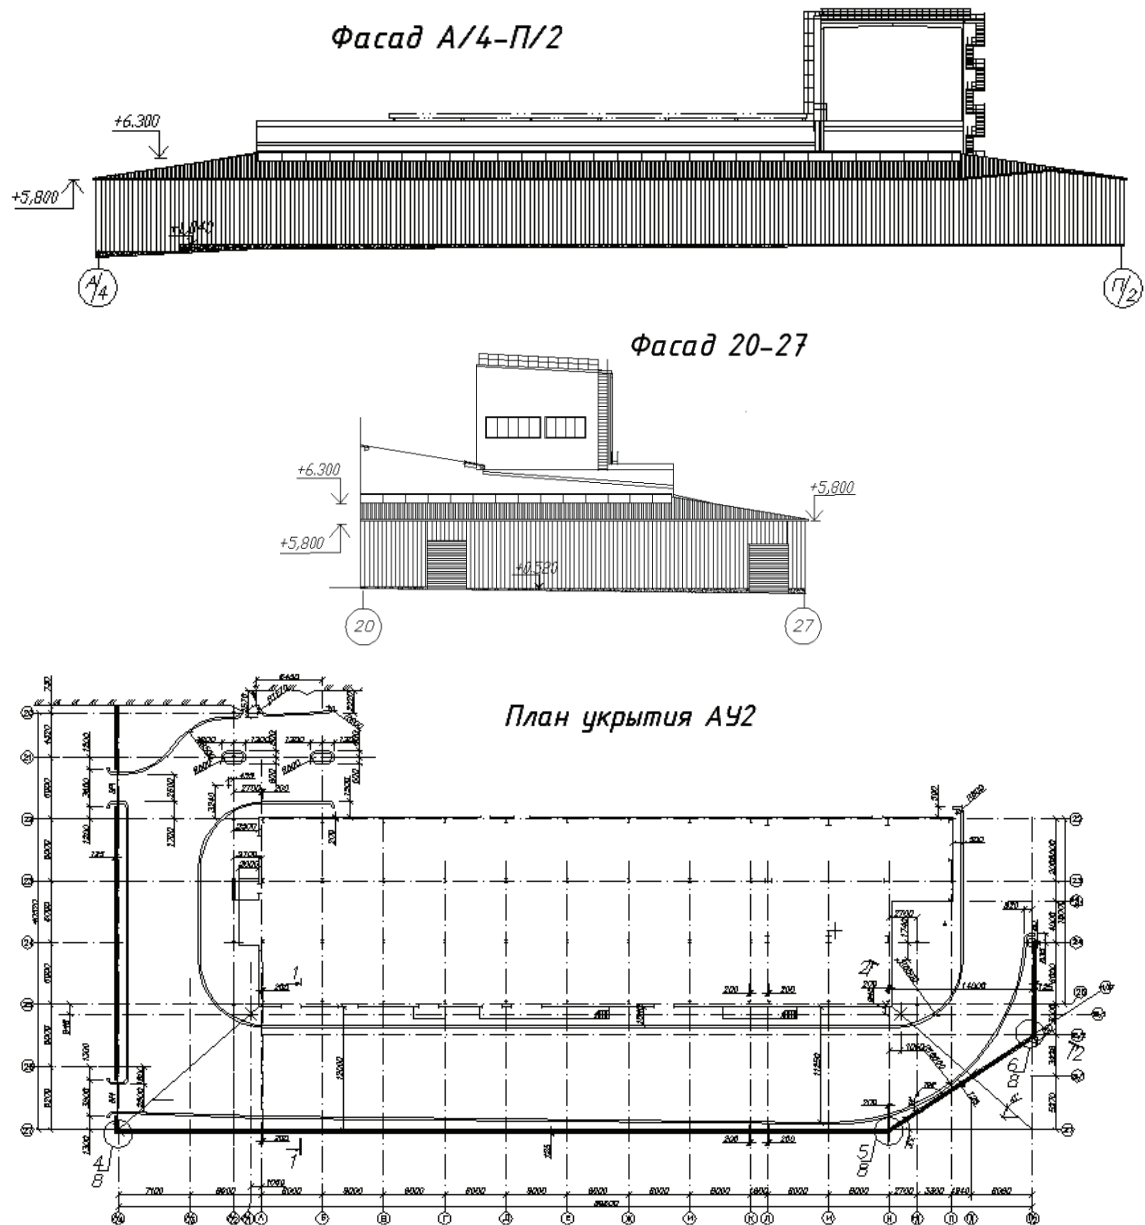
Конструктивное решение укрытия АУ2 (фасады, план).
